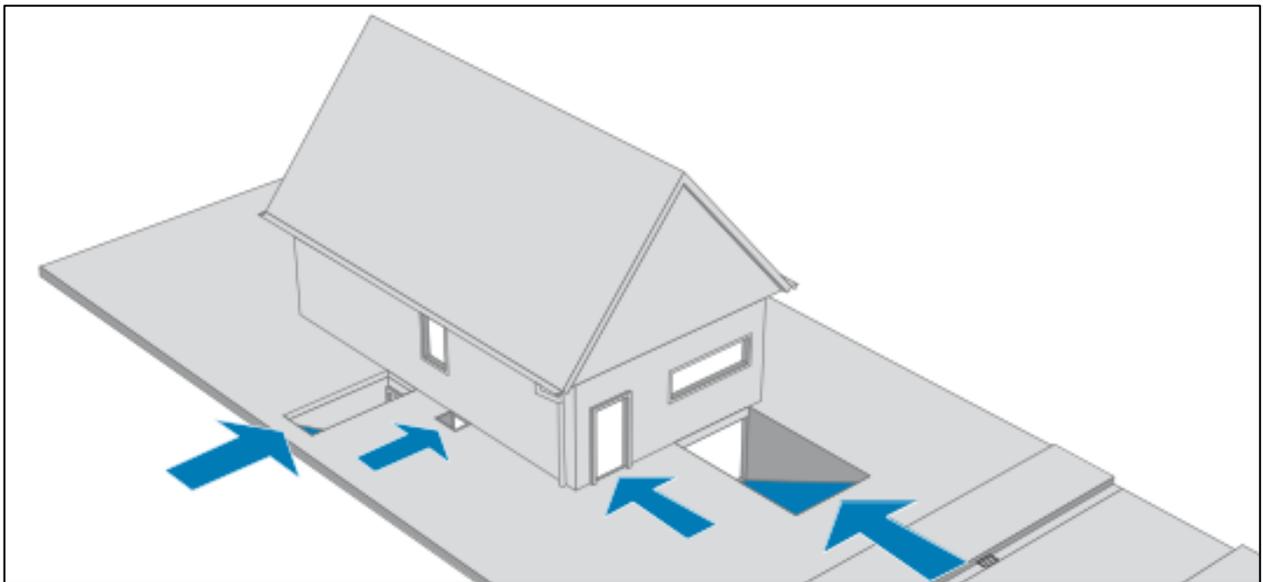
Eintrittswege für Oberflächenwasser in Gebäude [11]
